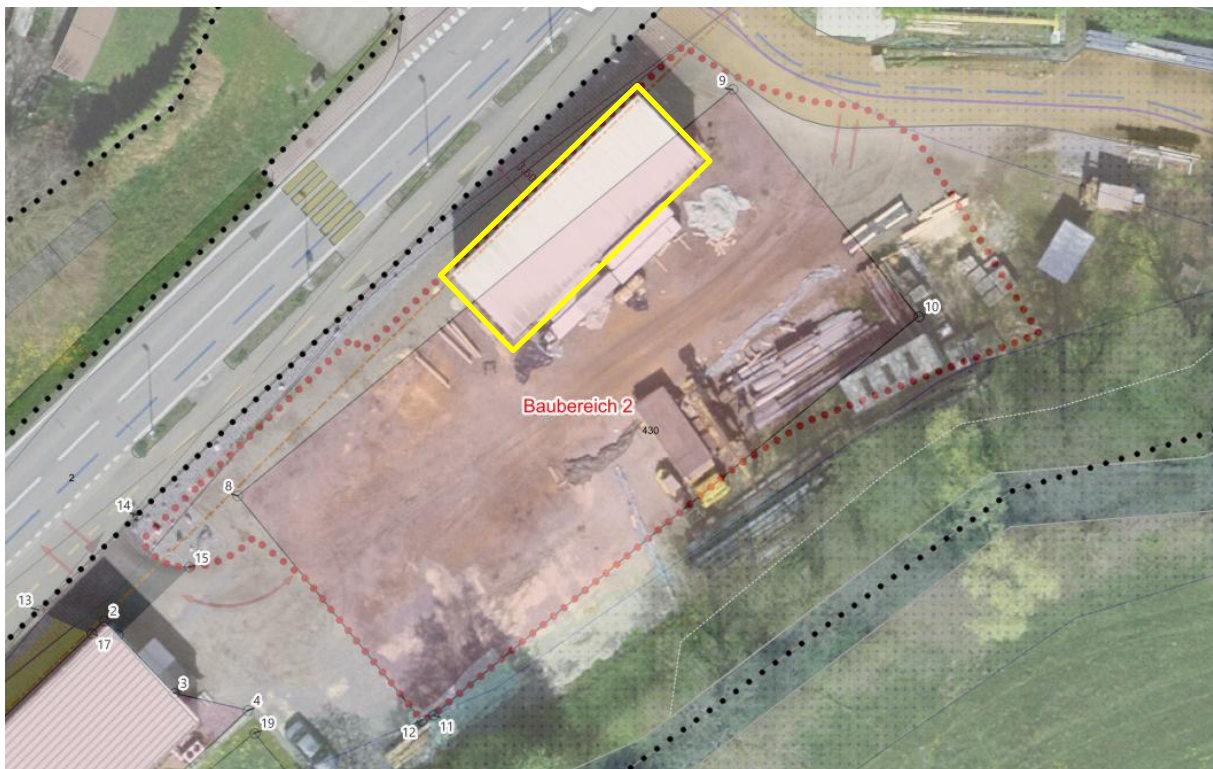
UeO-Plan mit hinterlegtem Luftbild inkl. genehmigtem Gewässerraum (Das Gebäude, welches teilweise in Baubereich 2 liegt (gelber Rahmen), wurde in Zwischenzeit bereits rückgebaut.)
